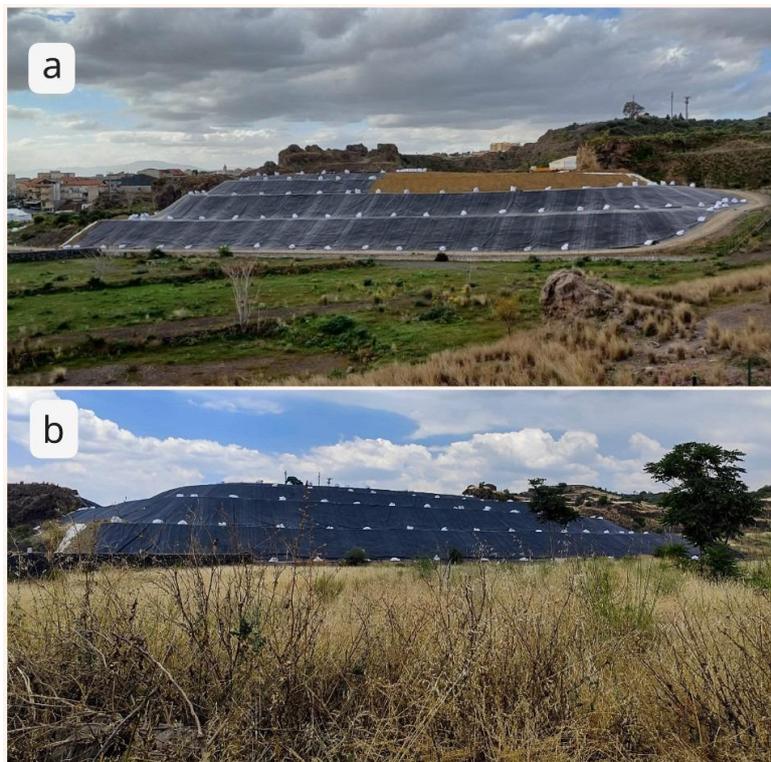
a – Intervento di sopra-copertura di cumulo; b – Vista da sud di cumulo con geomembrana di sopra-copertura, zona ex cava (dall'esterno cantiere)
